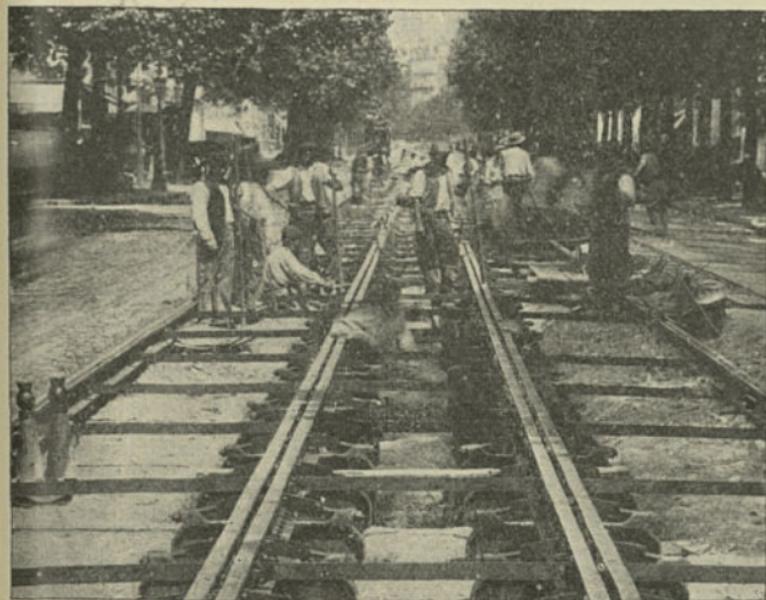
Construction d'une ligne de tramways électriques à caniveau souterrain.
